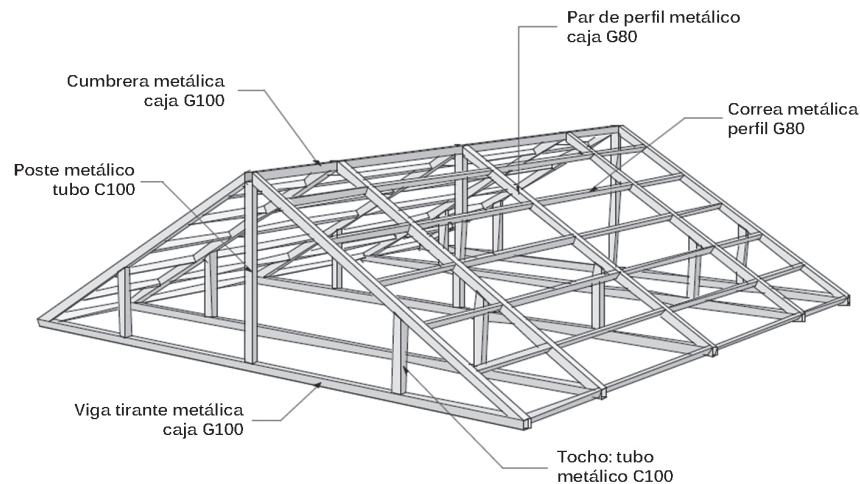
Detalle de los elementos de una cubierta metálica.
